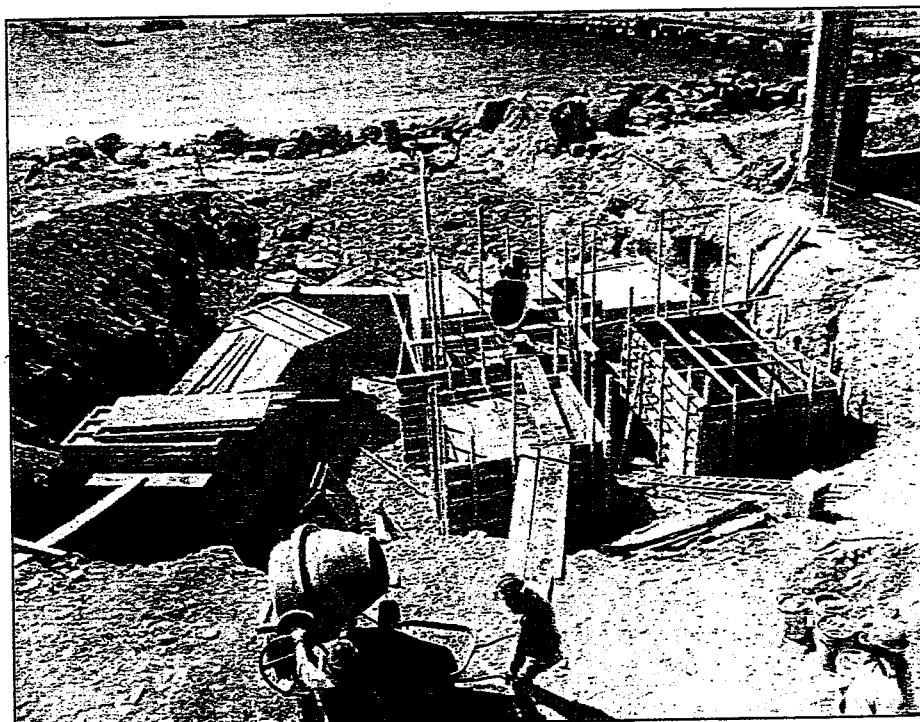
Vista panorámica de la falsa zapata Z14 vaciada y encofrado de otras falsas zapatas.
